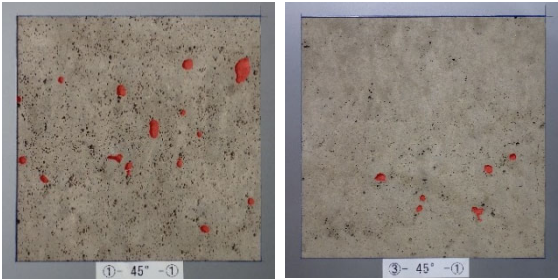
画像解析状況 (左: No. 1 右: No. 3)
